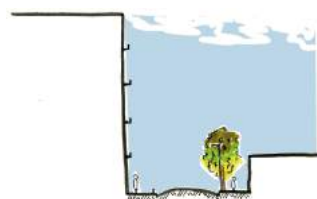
Esquema plano de aire calle d'Estadella (lado norte)
